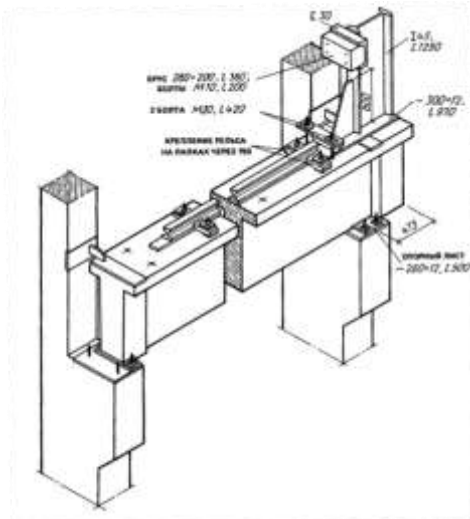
Опирание подкрановой балки на консоль колонны и конструкция концевого упора
